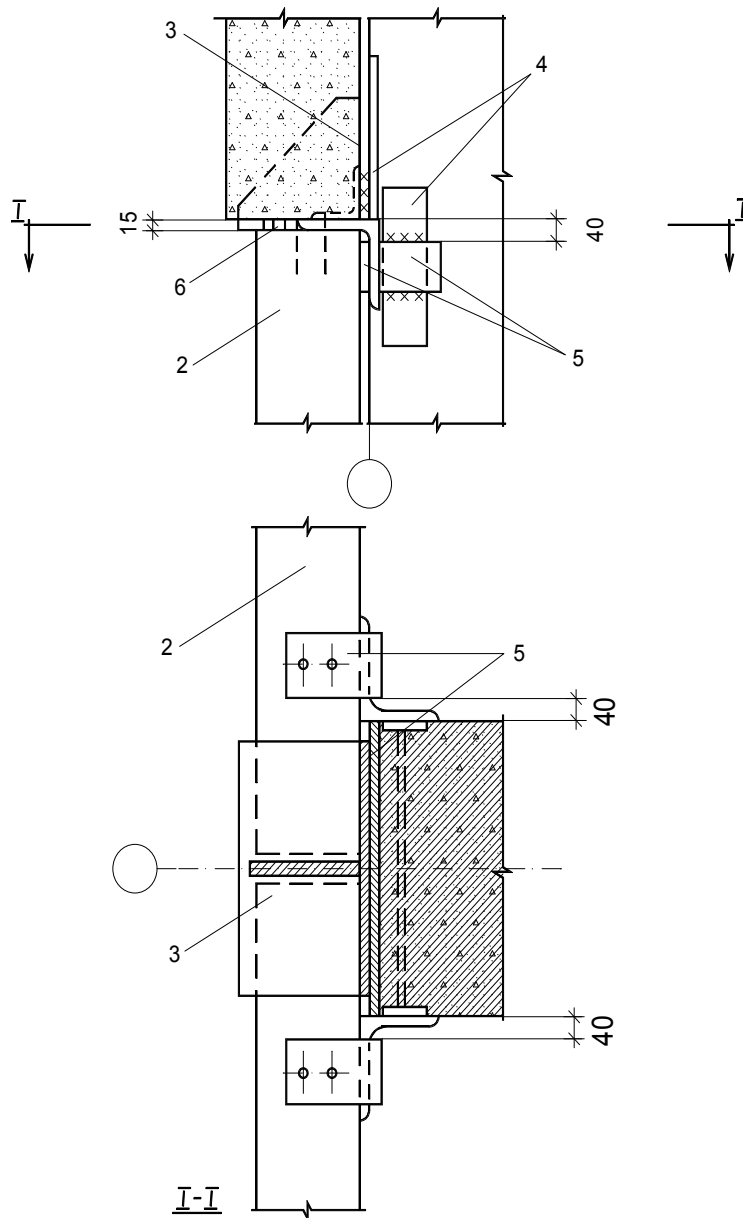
Кріплення панелей до колони крайнього ригеля біля рядової осі на рівні верху вікна: 1 – стінова панель; 2 – віконна панель; 3 – сталевий столик з прокатного кутика; 4 – закладні елементи колон; 5 – монтажні деталі з прокатного кутика для кріплення віконної панелі до колони; 6 – просмолена пакля
